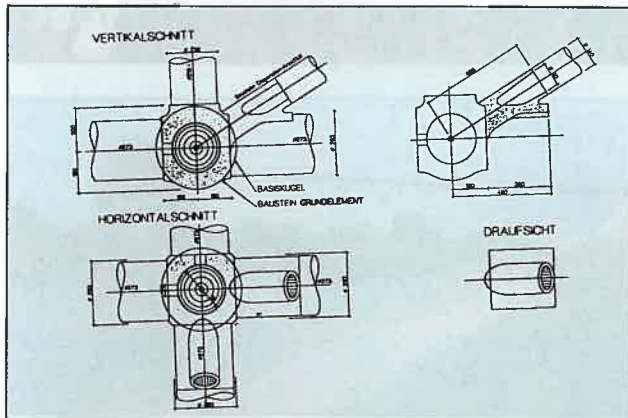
Die Raumfachwerkknoten des Daches der Halle 13, 1998 auf der Hannover Messe (Architekt: Ackermann und Partner, München)
